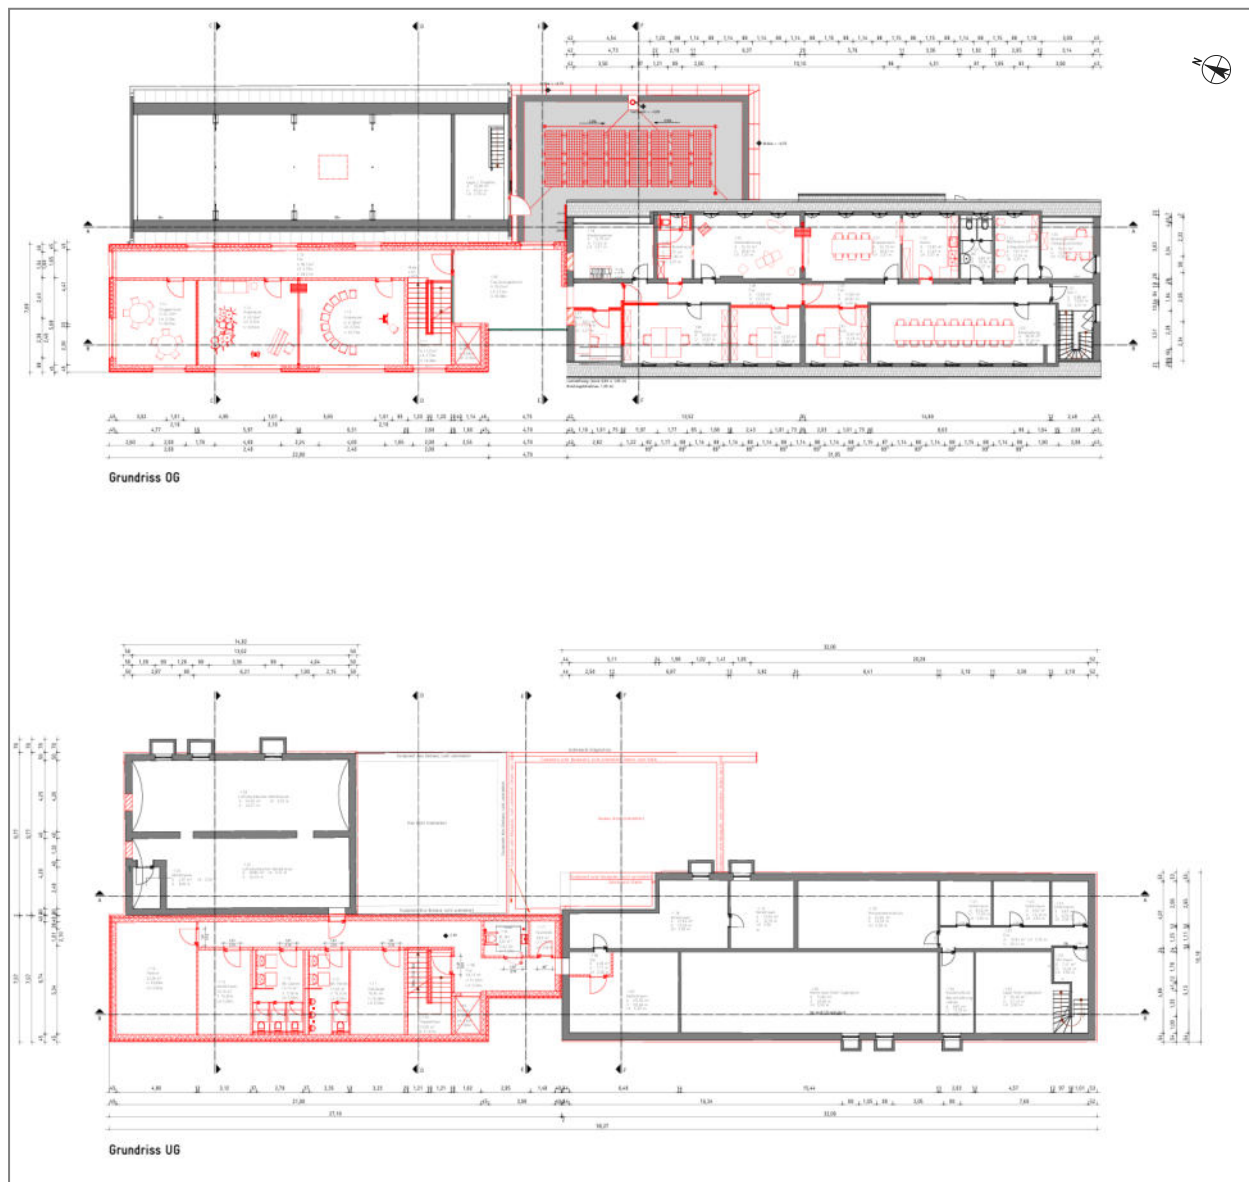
Ausschnitt - „Entwurfsplanung - Grundriss OG, UG“ (Datum: 04.12.2025, [20]), unmaßstäblich
